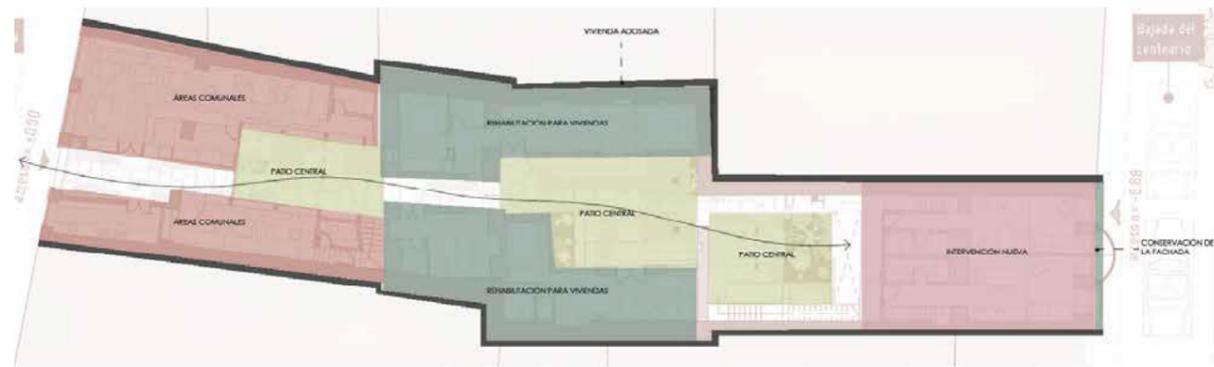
Diagramas de zonificación planta baja Fuente: Elaboración propia
